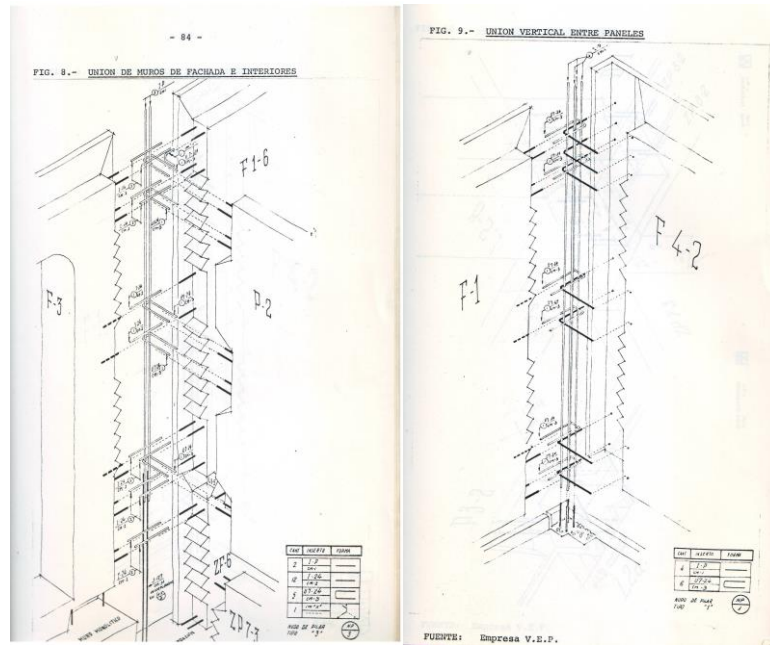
Uniones de muros en sistema KPD. Fuente: Leónidas Zapata (1983).
